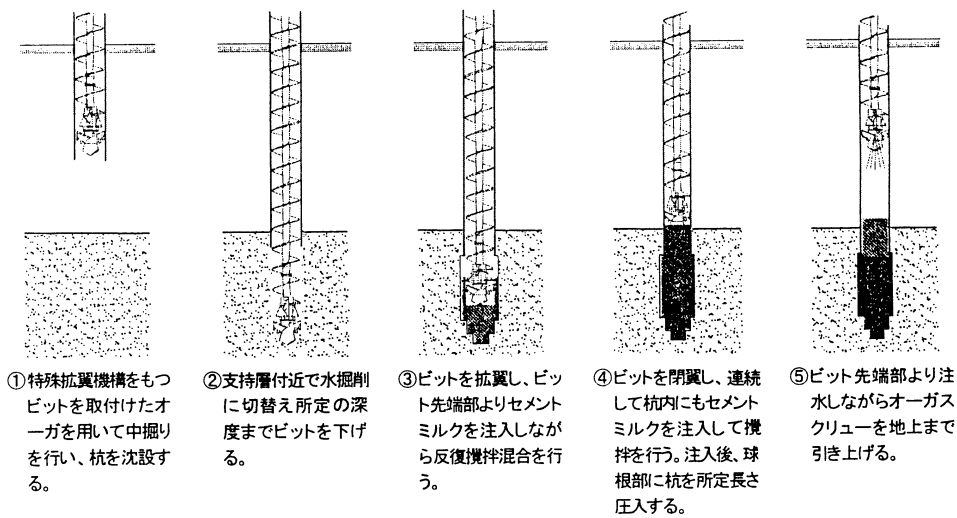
KING 工法の施工手順 (出典 5.6-①)
